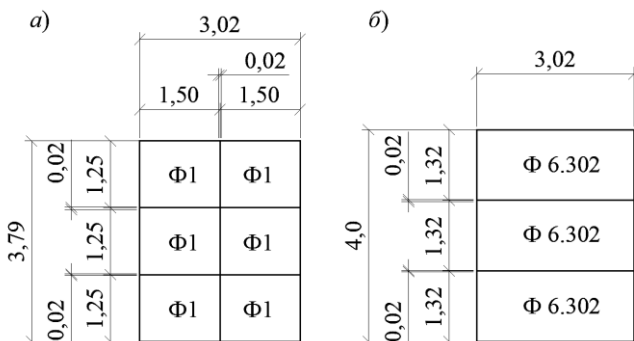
Схемы компоновки фундаментных плит (а) и блоков (б) водопропускной трубы
